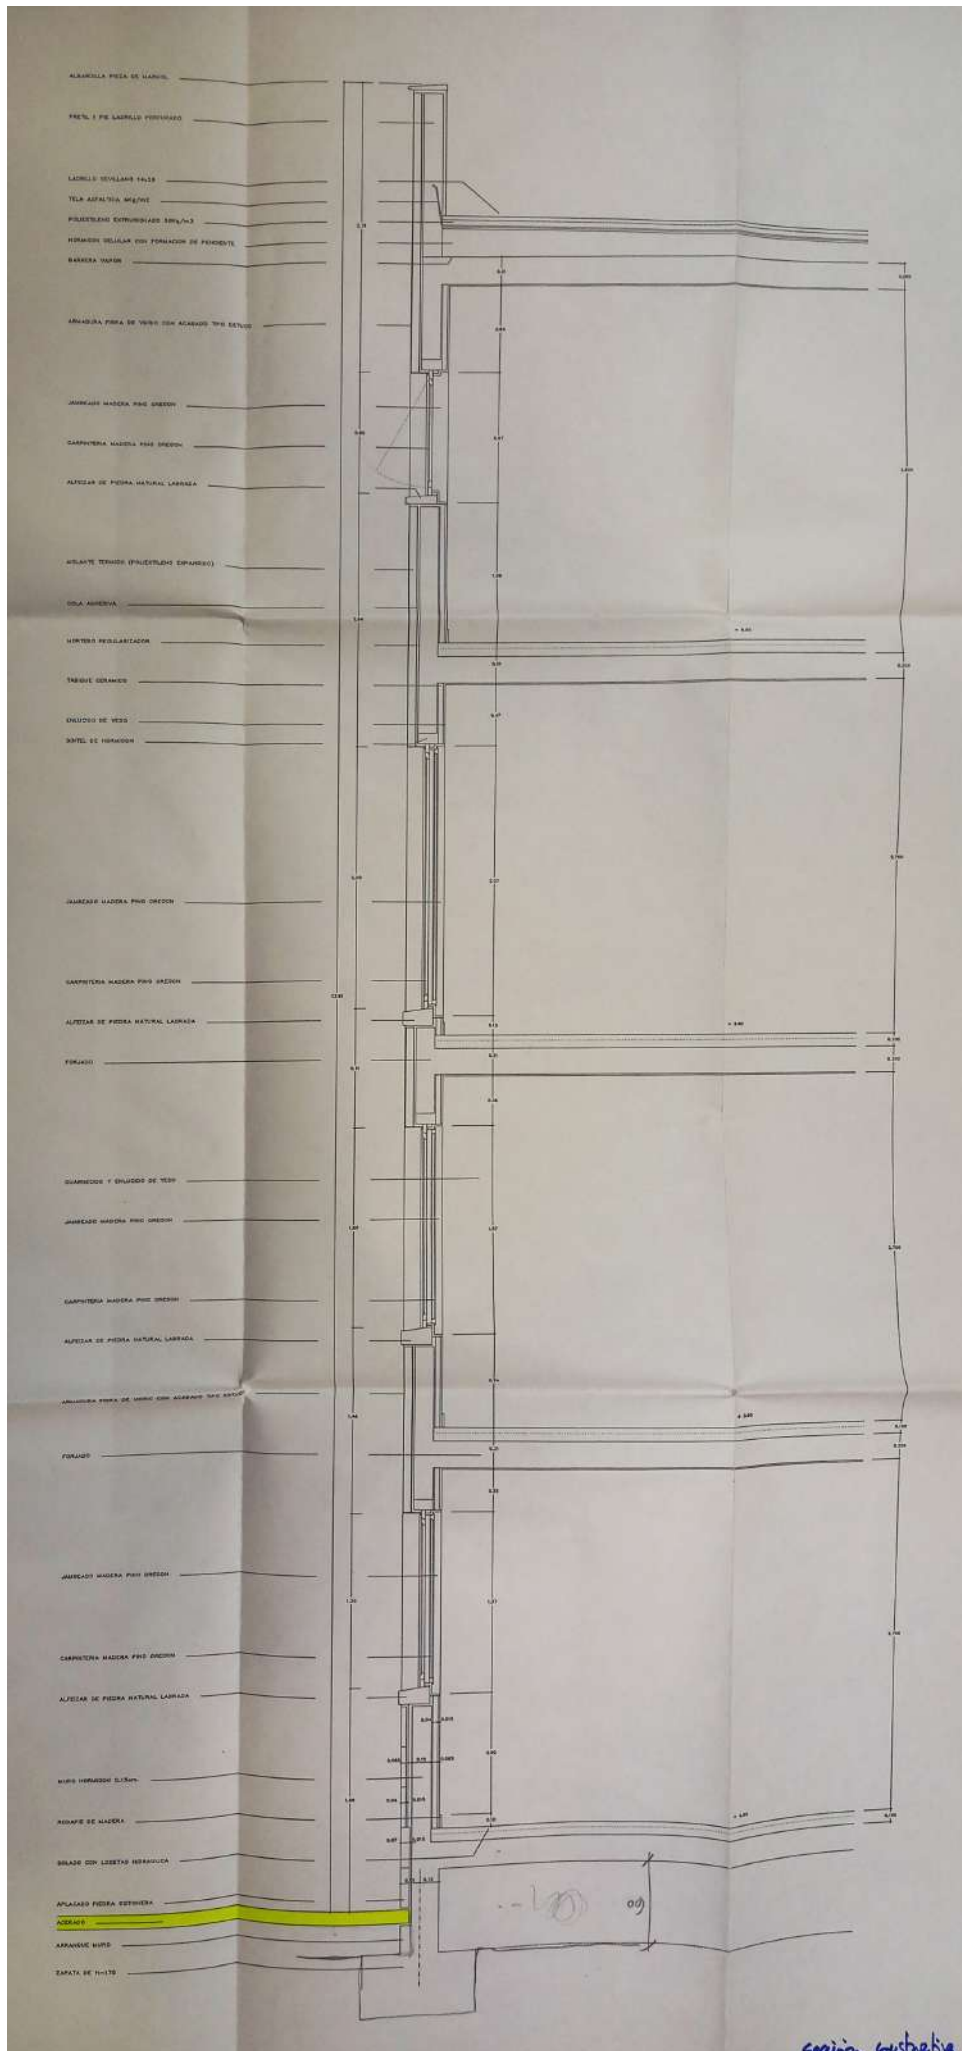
Sección constructiva. Proyecto de ejecución.
